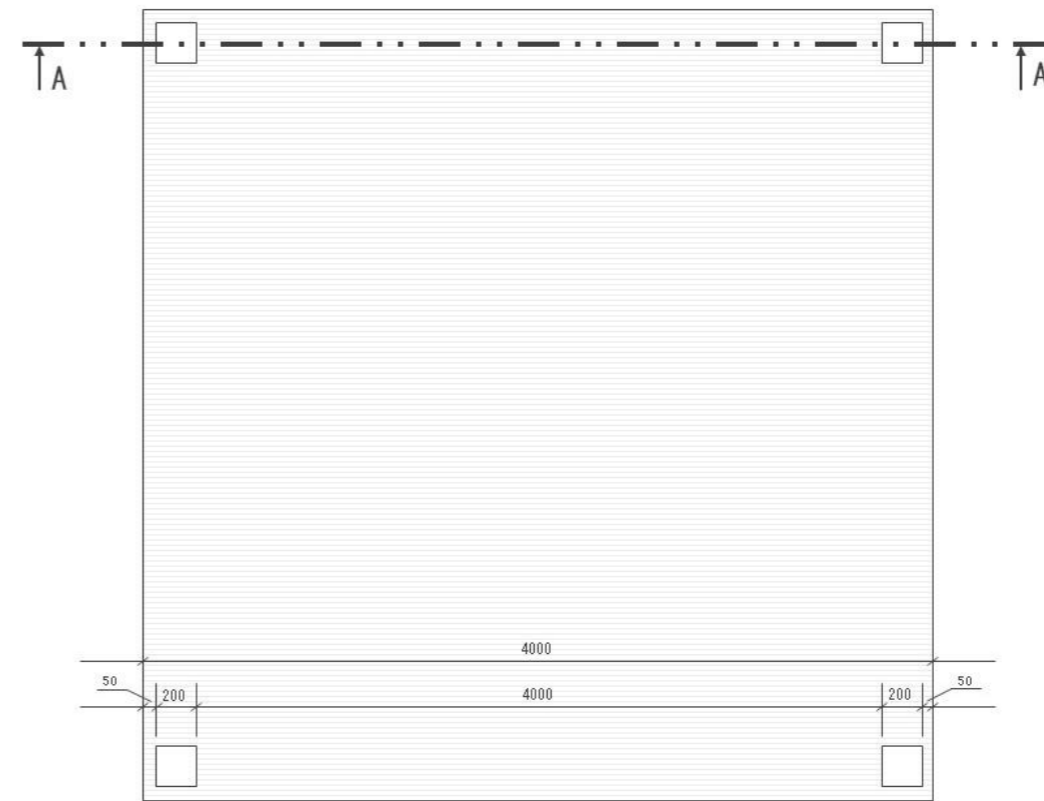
Technický detail – dřevěná lávka (zdroj: vlastní)
